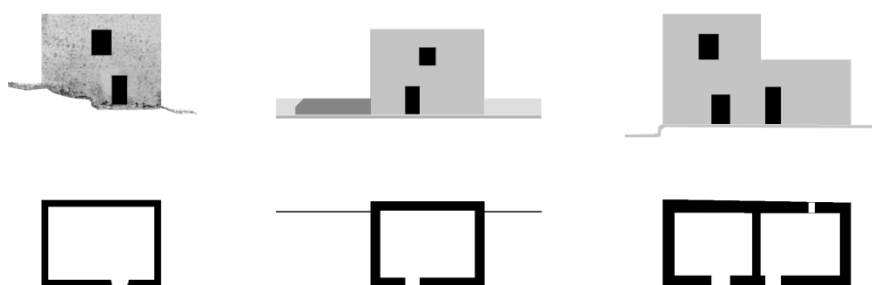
Planta y alzado de la algorfa de *Can Jesus*. Fase 1.
